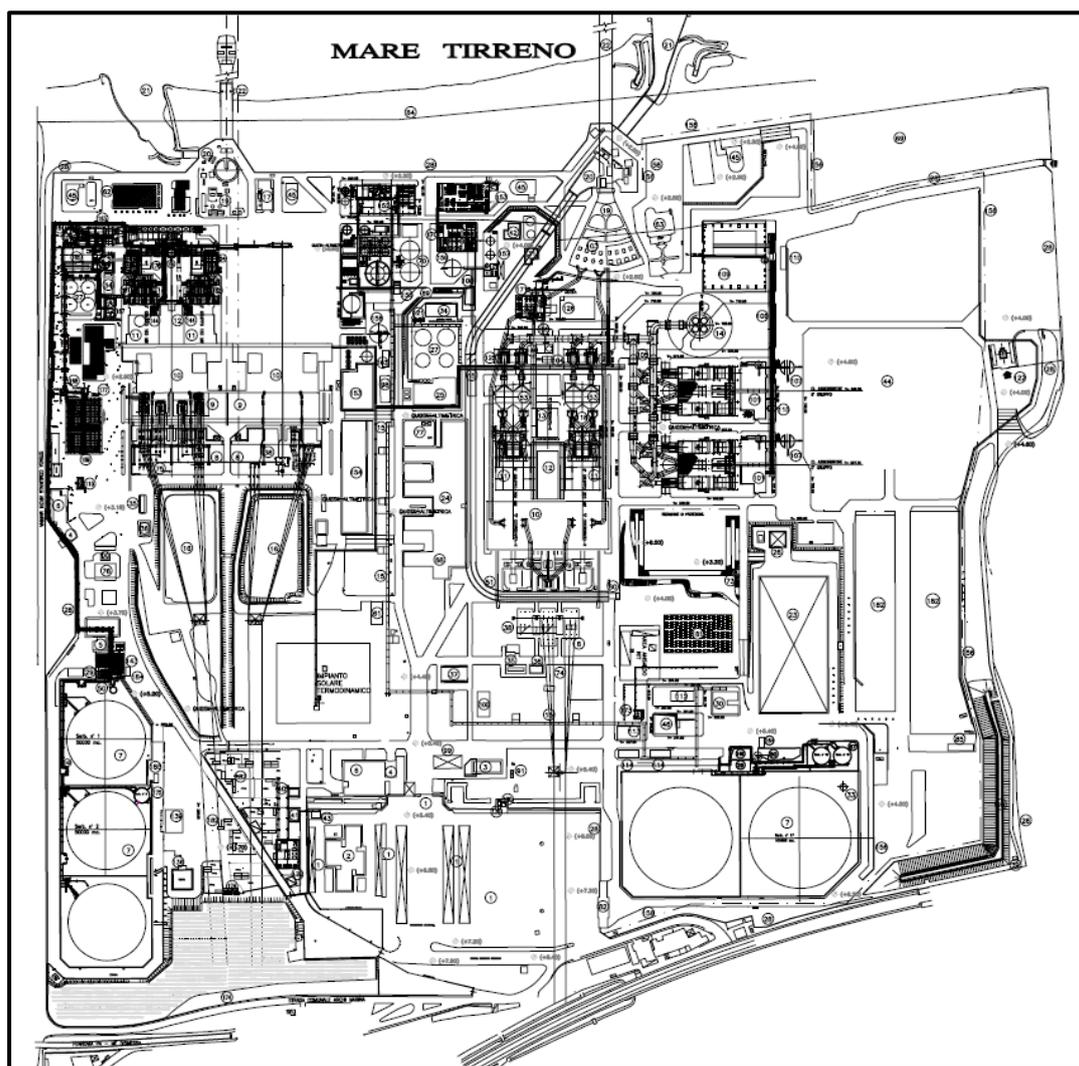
Centrale di San Filippo – Planimetria dell'impianto esistente (assetto attuale)
